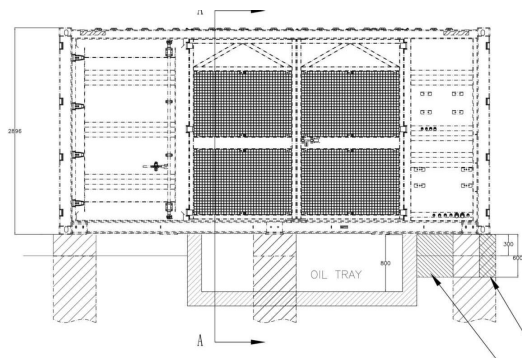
b – Sezione delle cabine di trasformazione fissata alle fondazioni
